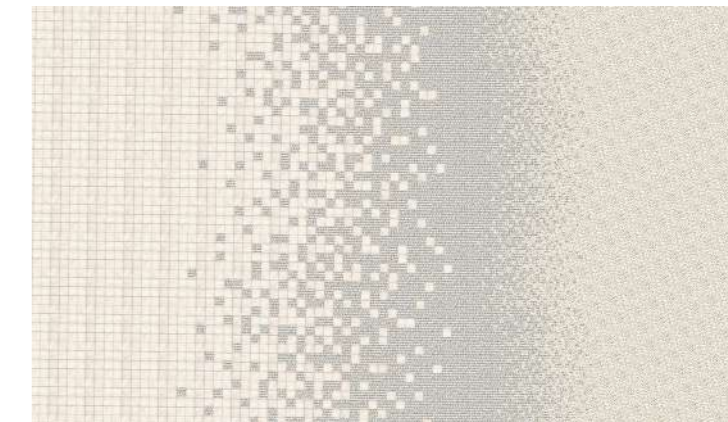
Transição de pavimento entre lajetas em lioz existentes e calçada em granito e vidro.
